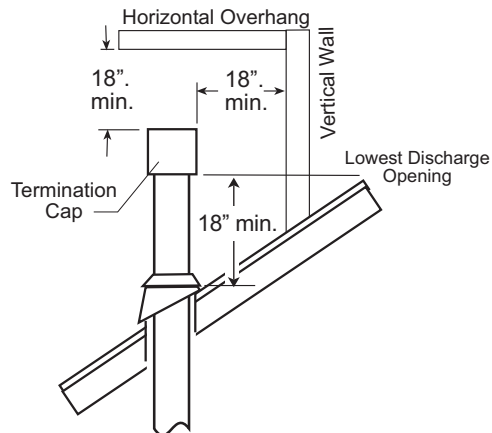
Hauteur minimale de terminaison verticale et dégagement du toit.
